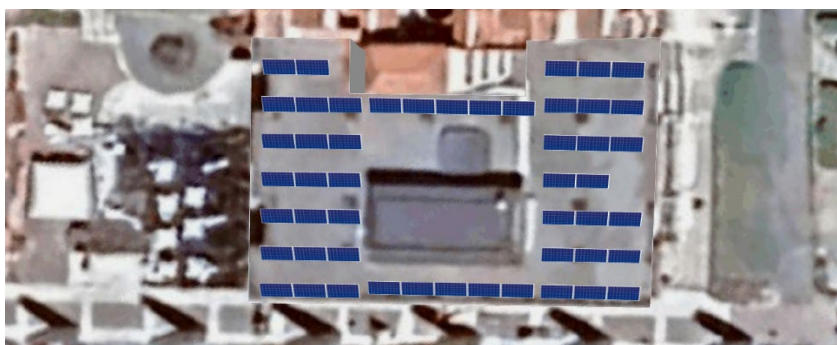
Distribució panells sobre coberta Centre Cívic. Empuriabrava.
